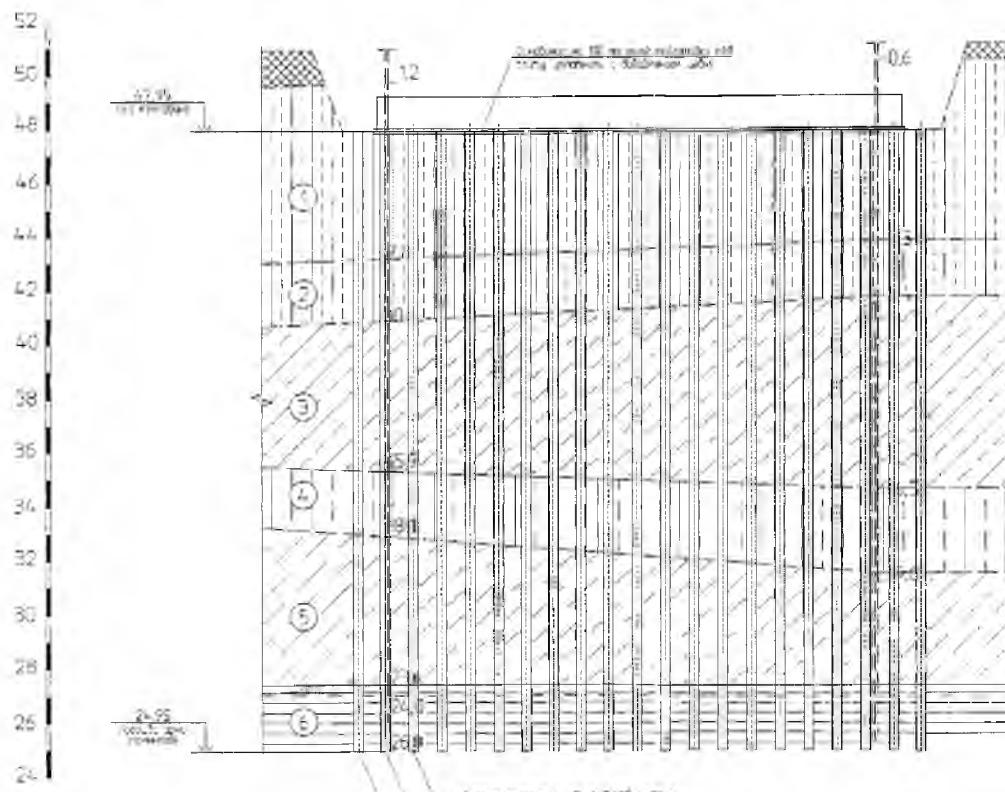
План розташування армоелементов під фундаментної плити
